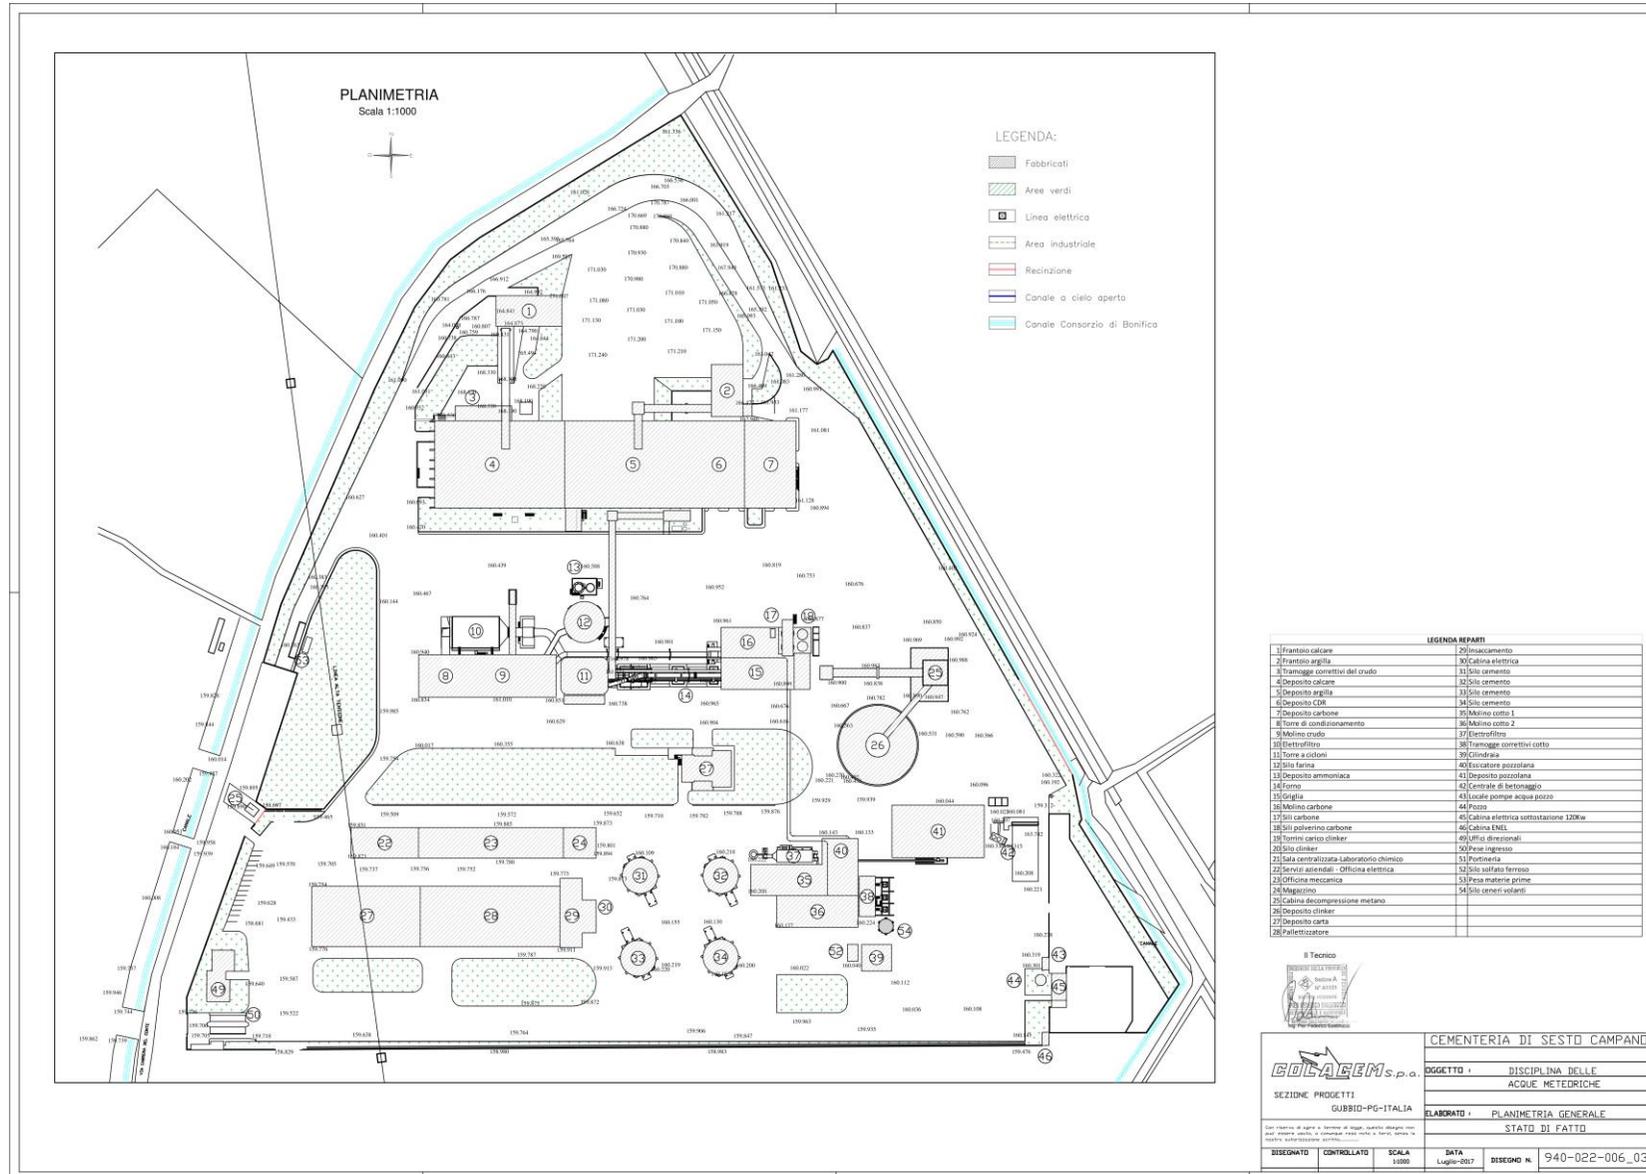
planimetria generale dell’installazione: assetto “ante operam”
